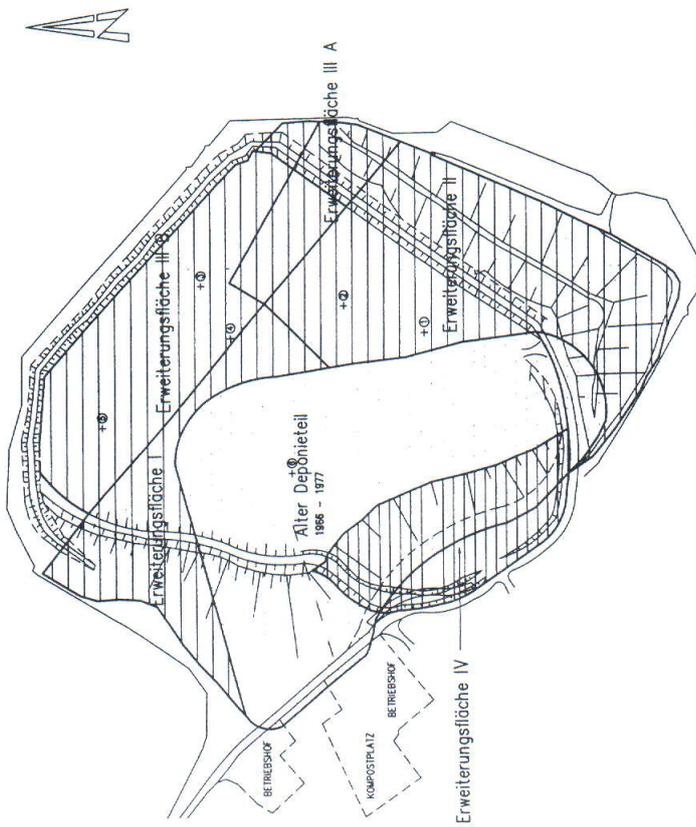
Lageplan der Erweiterungsabschnitte der Deponie Konstanz - Dorfweiher
